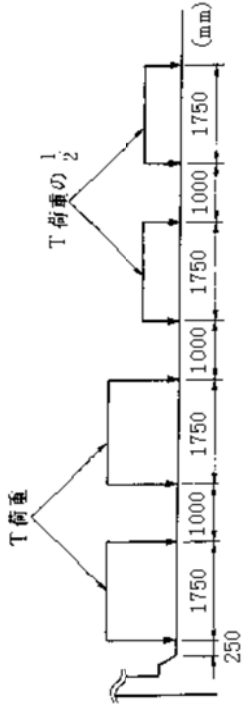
主桁設計時の T 荷重の載荷方法
